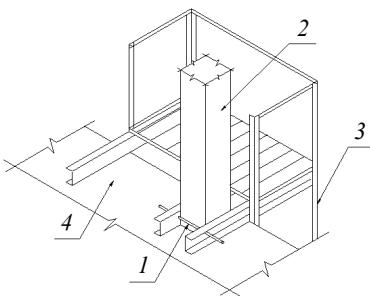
Схема крепления площадки к колонне: 1 – пальц (штырь – круг ф25, L = 1,2 м); 2 – колонна; 3 – навесная площадка; 4 – перекрытие перекрытия (ТТК на кирпичную кладку стен в зданиях с несущими стенами под существующим перекрытием)
